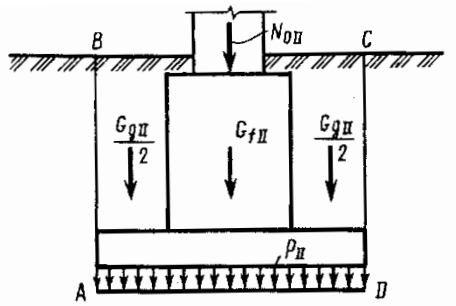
Расчетная схема центрально нагруженного фундамента.
